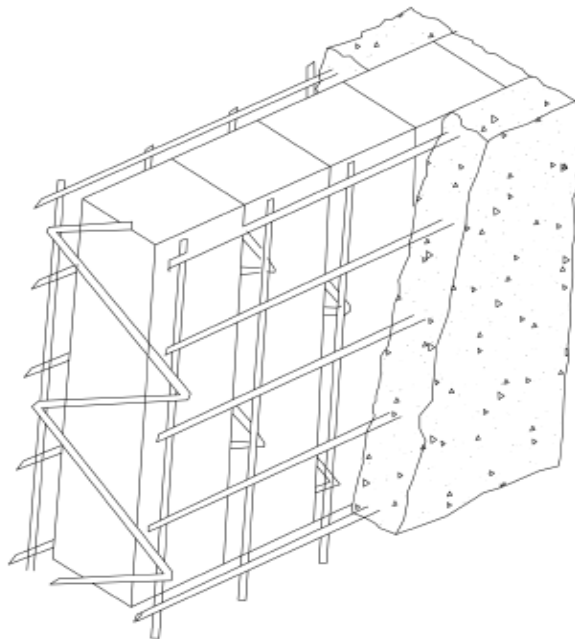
Este sistema es usado en muros que consta el relleno de plancha poliestireno (tecnopor) sujeta por una malla metálica y cubierta con concreto
